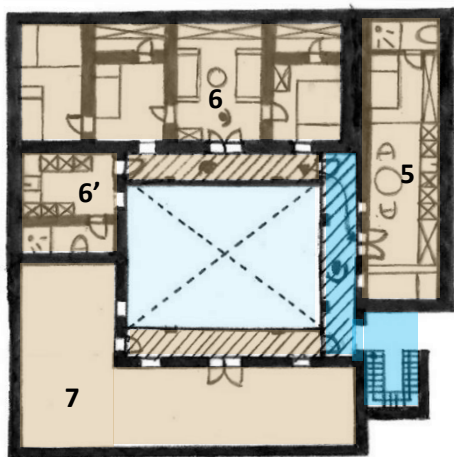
Croquis plan du 1er étage avec segmentation des espaces privés et collectifs
